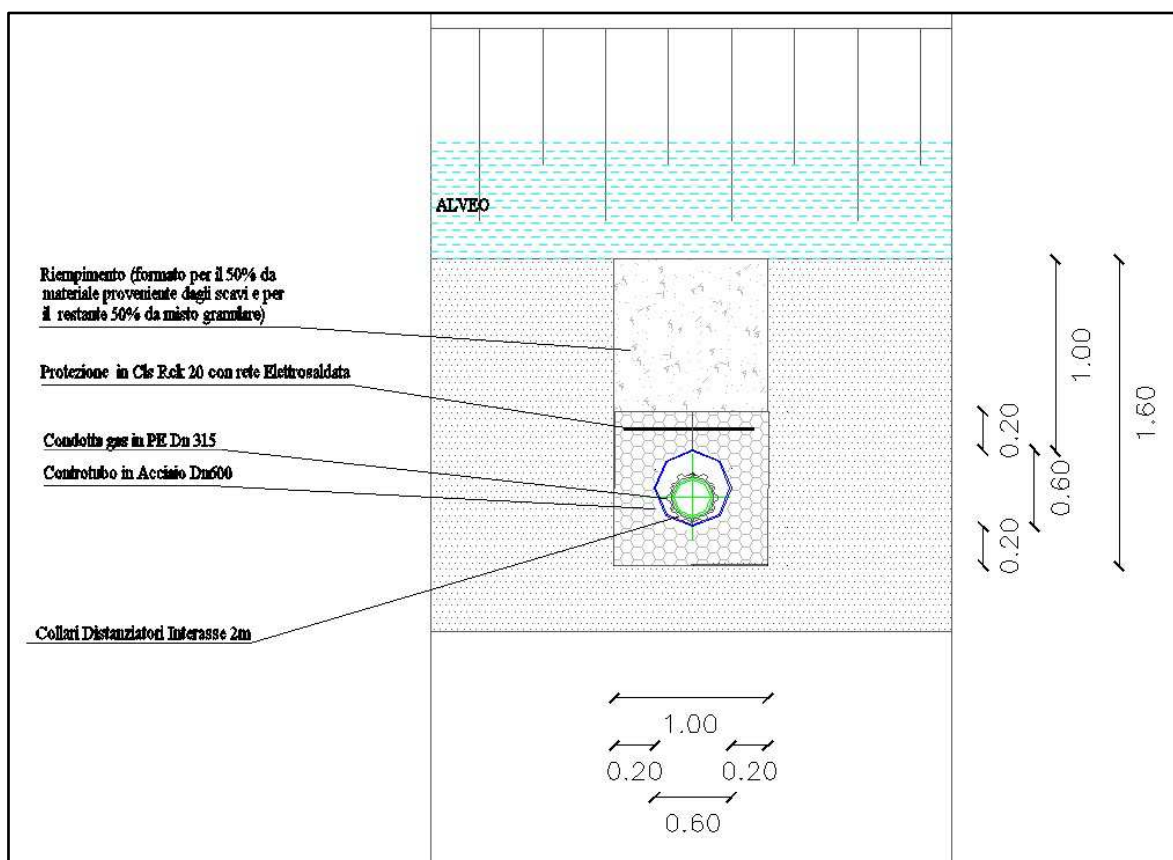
Sezione Trasversale attraversamento canale tombato via Tunisia (Elaborato I.11)
